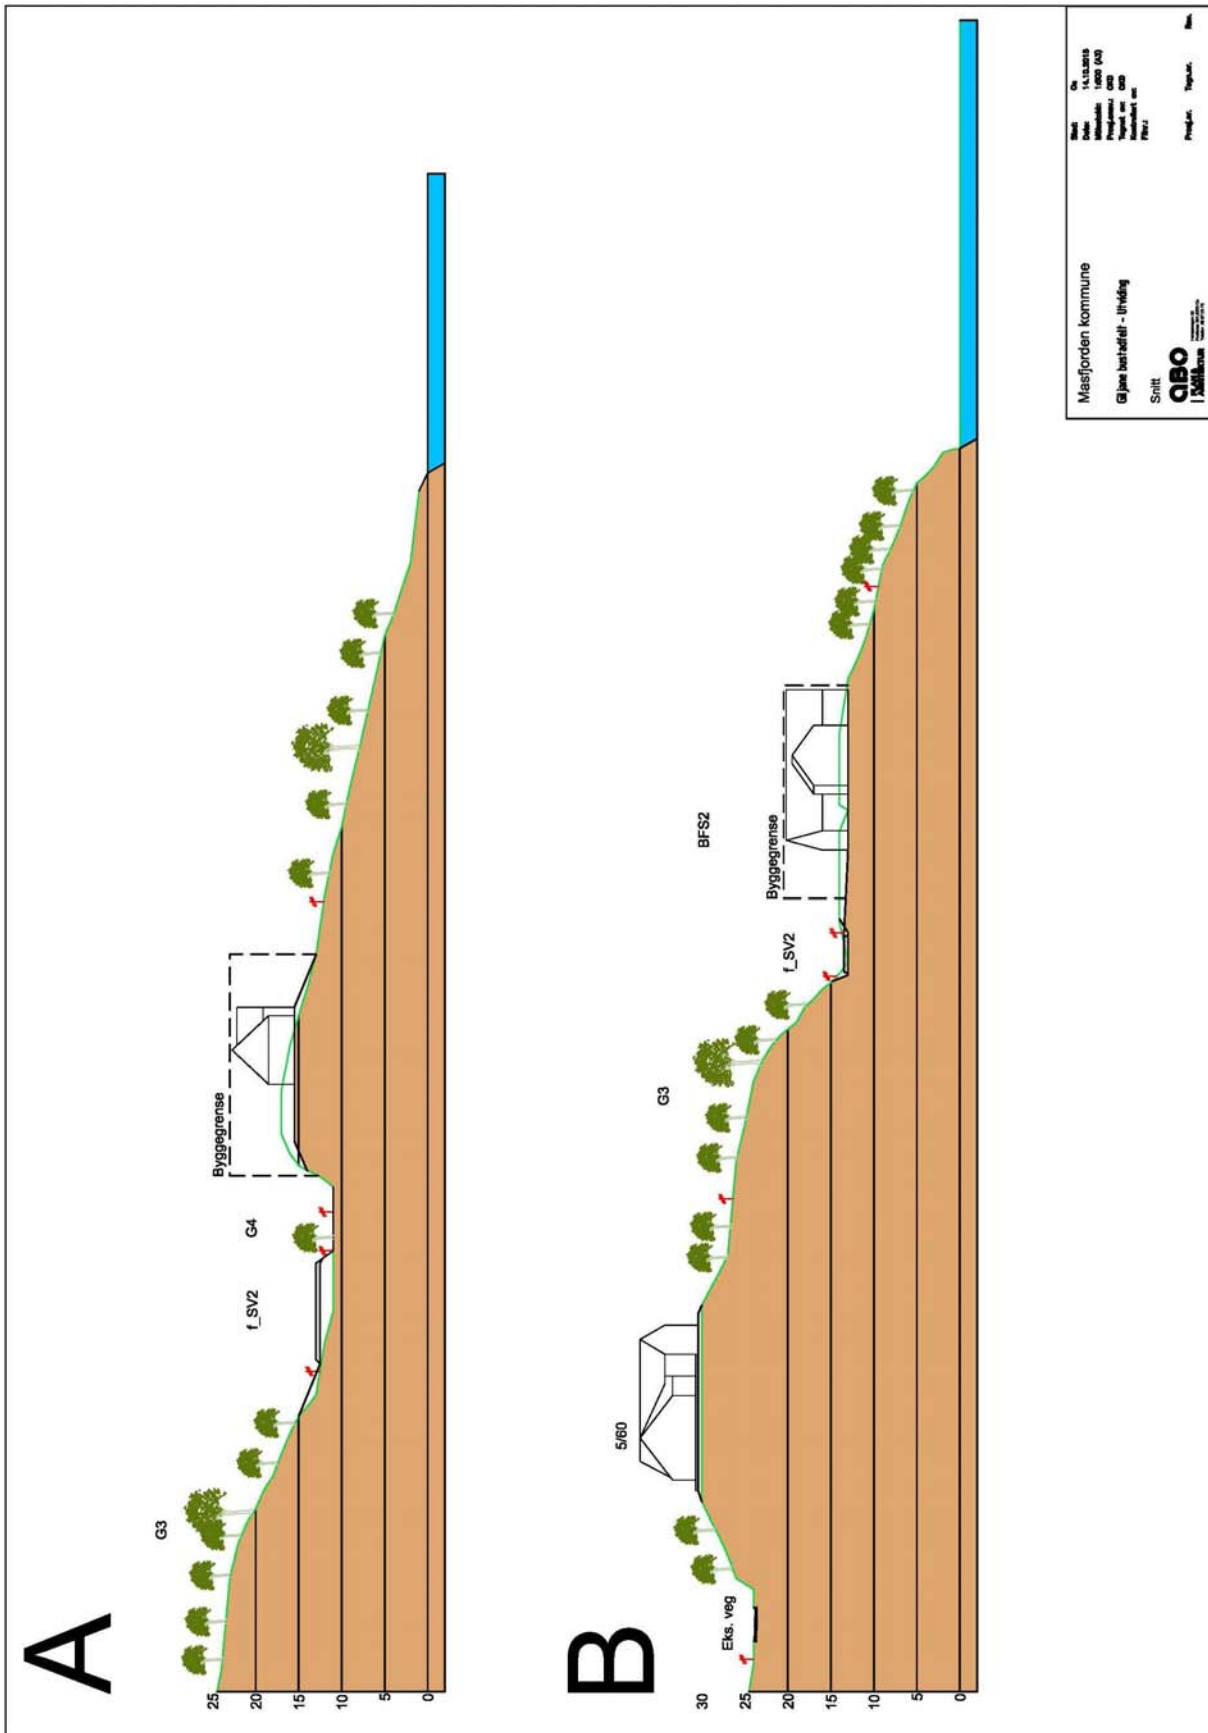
Illustrasjon som viser at planlagd utbygging vert liggjande lågare i terrenget enn eksisterande utbygging.
